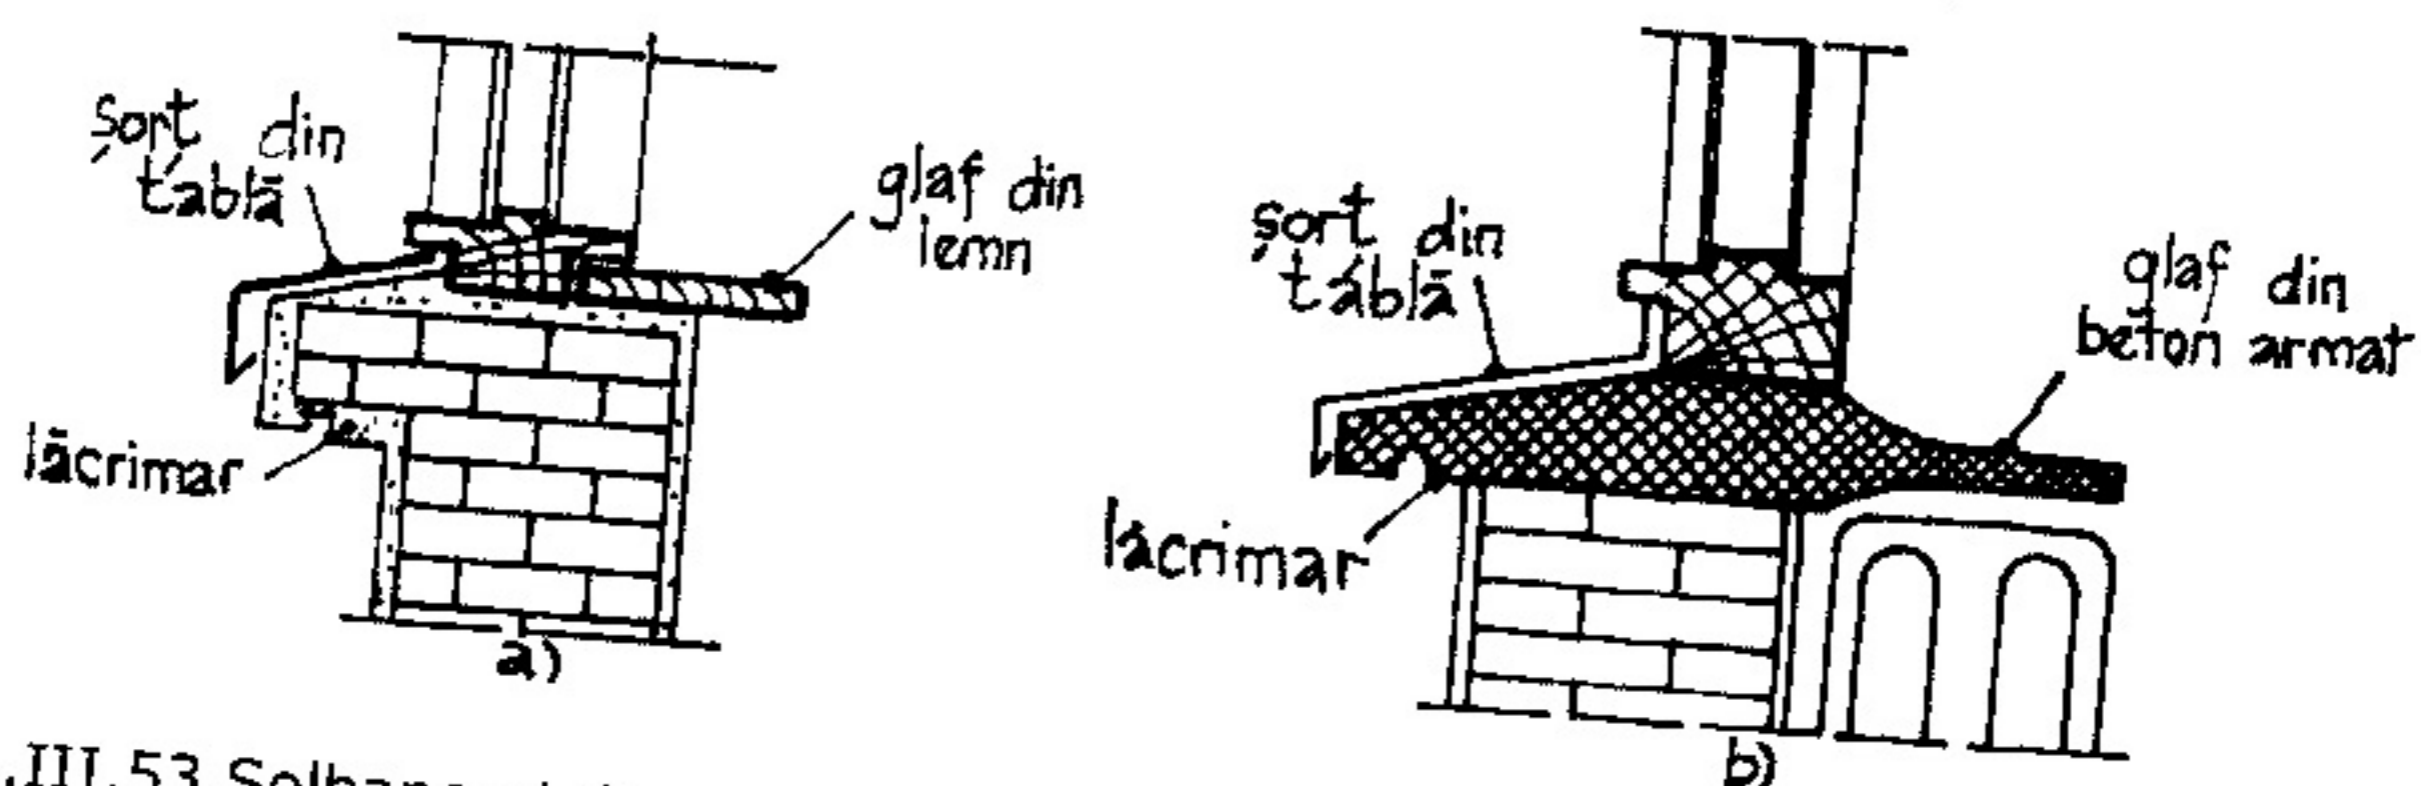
Solbancuri din: a - zidărie de cărămidă; b - beton armat prefabricat
